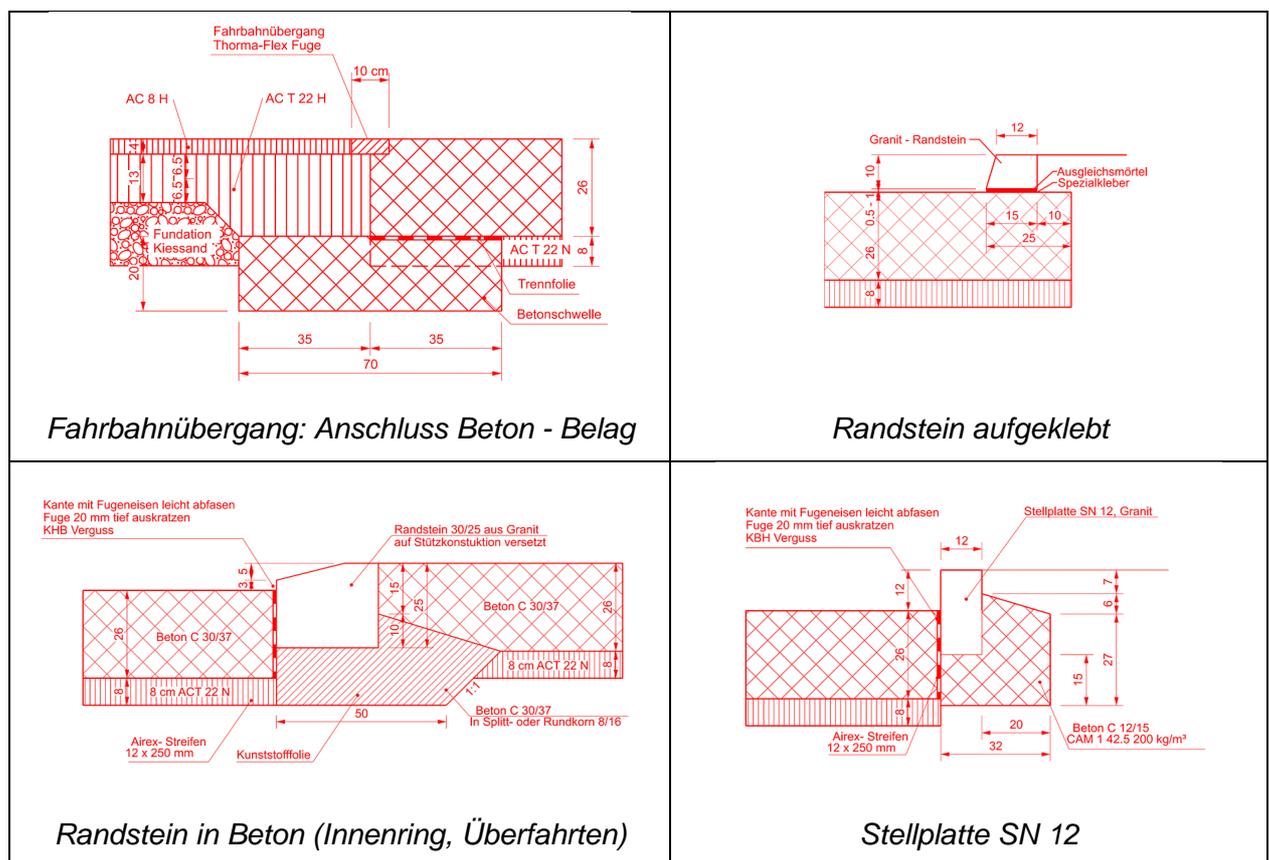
Übersicht über die Fugen und Randabschlüsse für den Bau des Betonkreisels (ohne Massstab)
